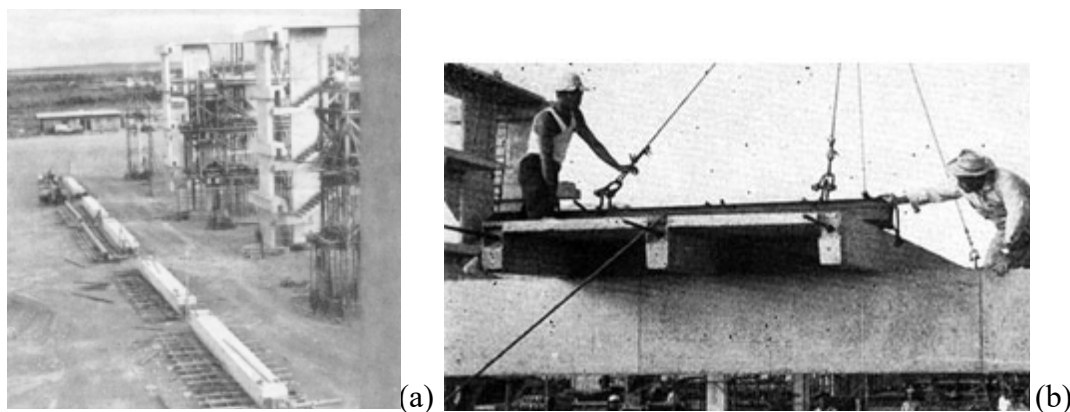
Construção da Colina: (a) protensão das vigas duplas longitudinais (b) içamento das lajes nervuradas. Fonte: ACRÓPOLE, 1970
